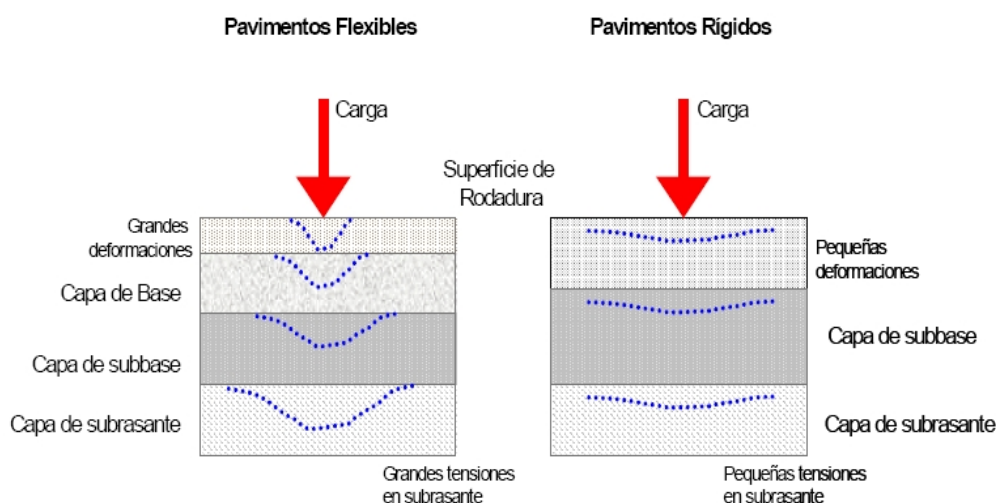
Comportamiento de pavimentos flexible y rígido.
